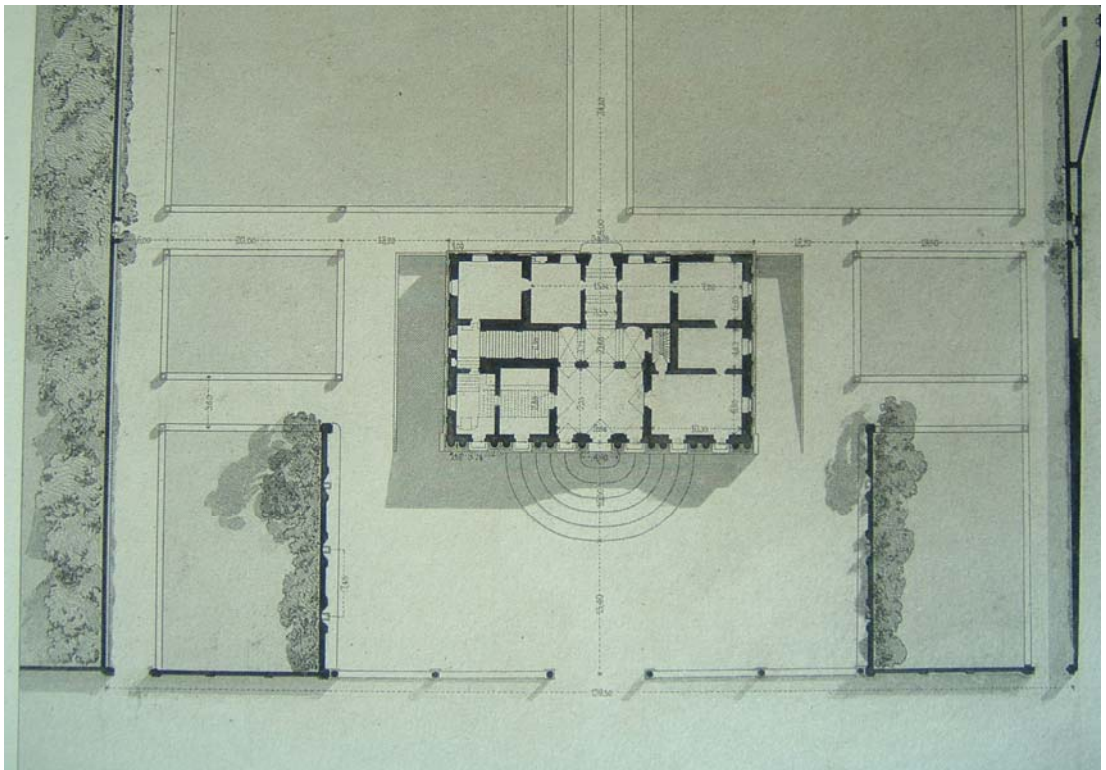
Pianta di Villa Imperiale Scassi con la sistemazione esterna (da R. Reinhardt 1886, tav. 83-84) Particolare con la pianta della villa in relazione al cortile che la separa dalla strada e all'asse centrale del giardino.
